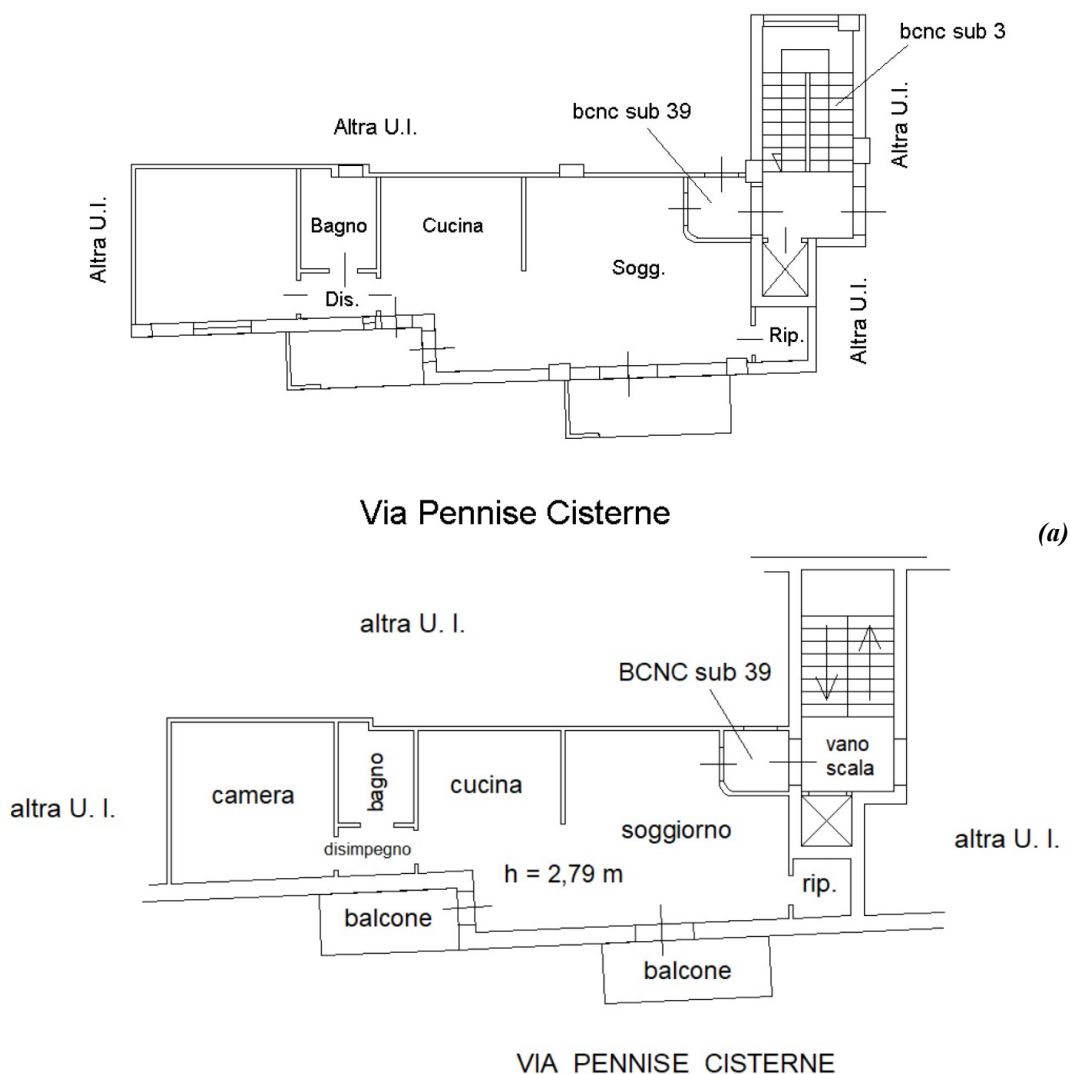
Planimetrie dell'appartamento ubicato alla via Emilio Dotoli n° 19 Scala B – interno 3 - piano 2: planimetria catastale (a); planimetria attuale (b).
